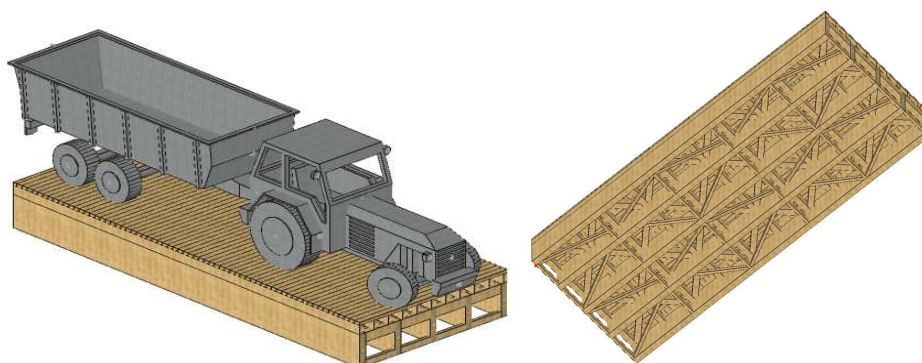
Axonometría superior e inferior de un puente formado por vigas, riostras y viguetas de MLE
